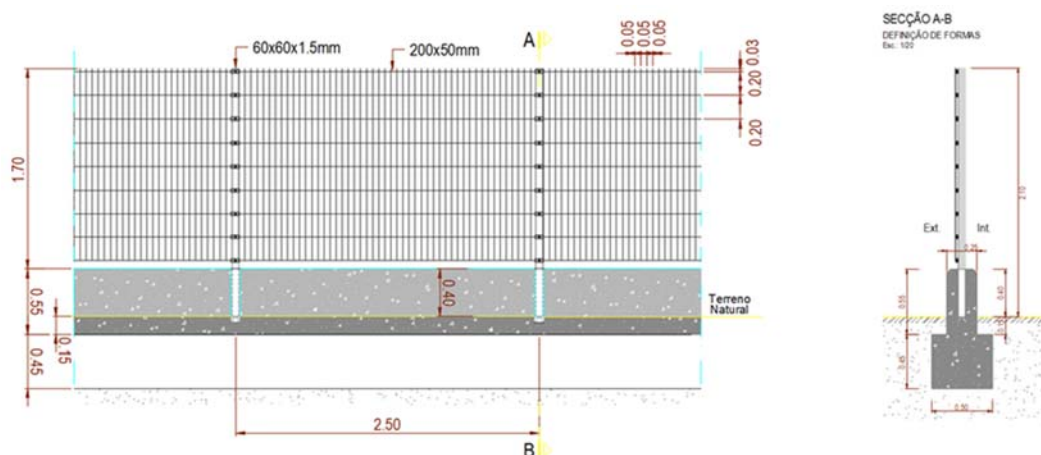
Alçado e corte tipo para vedação em Estações e Apeadeiros
